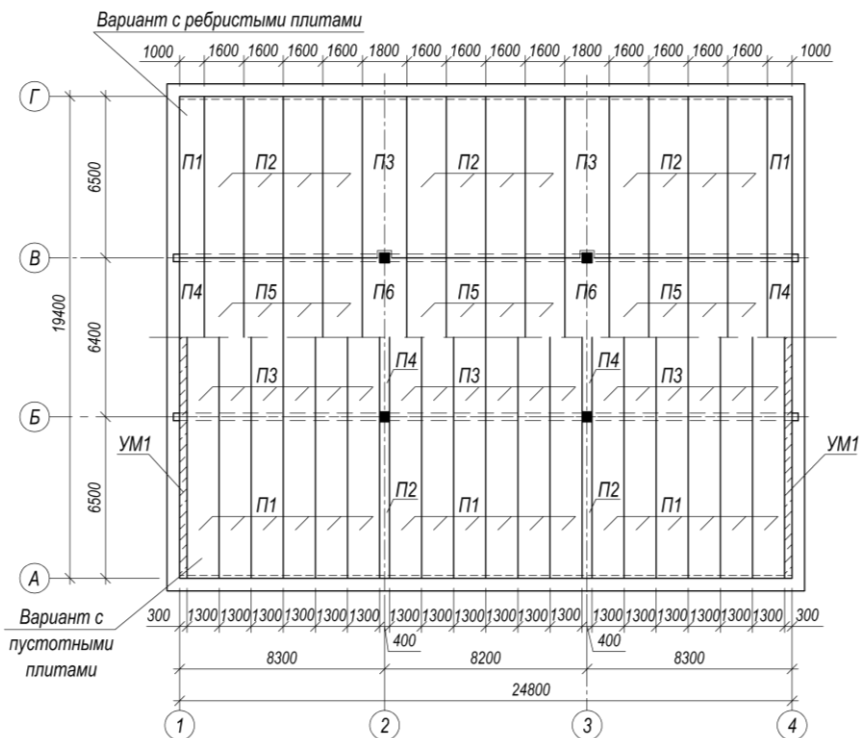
Раскладка в плане перекрытия сборных плит (2-й вариант)
